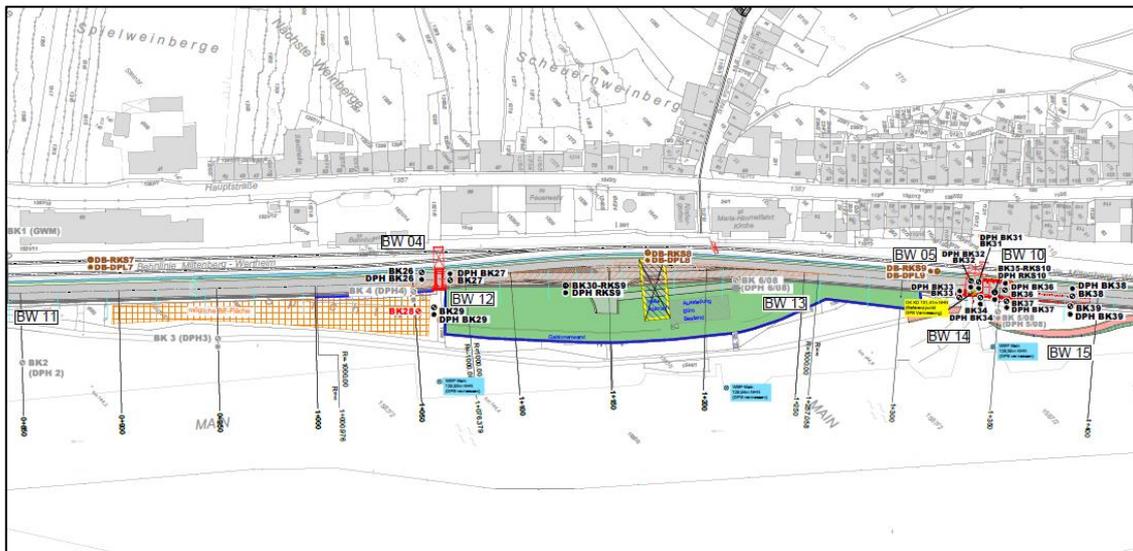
Lageplan der Aufschlüsse im Plangebiet
